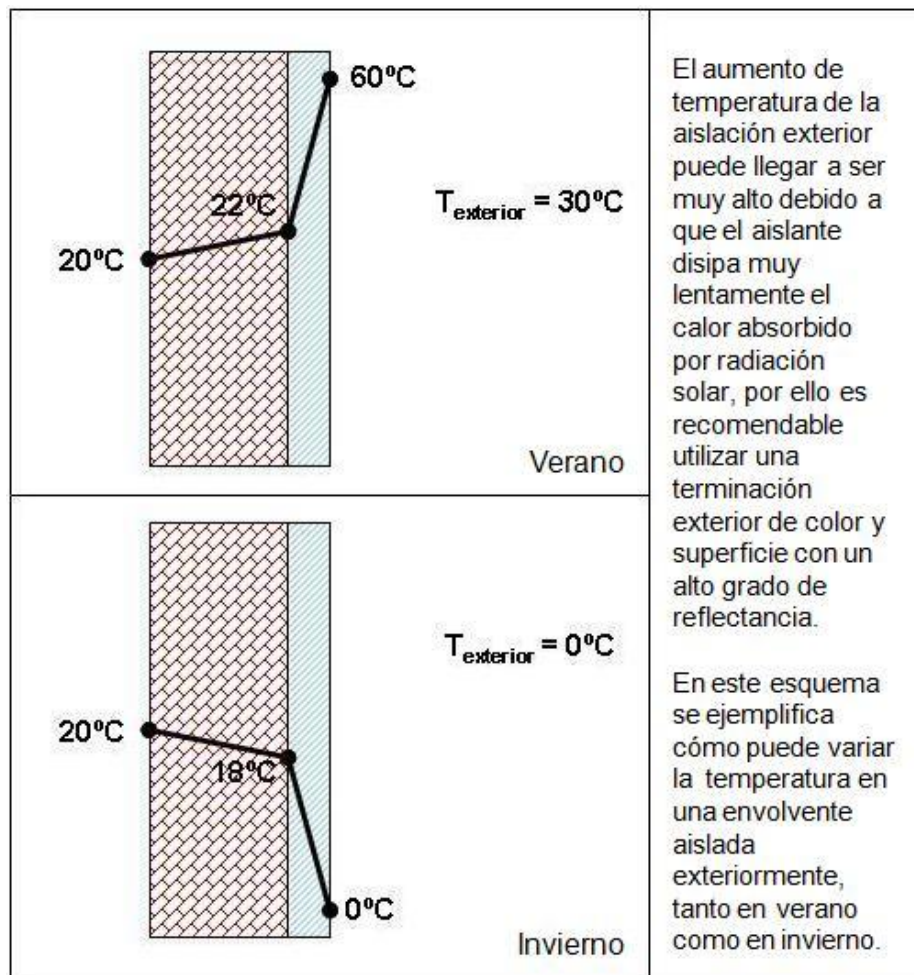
h. Temperaturas en un muro aislado exteriormente.
